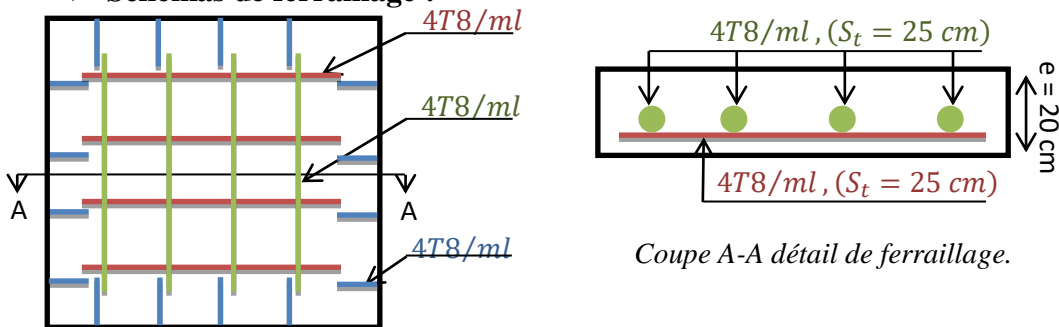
Schéma de ferrillage de la dalle au-dessous de l’ascenseur.
